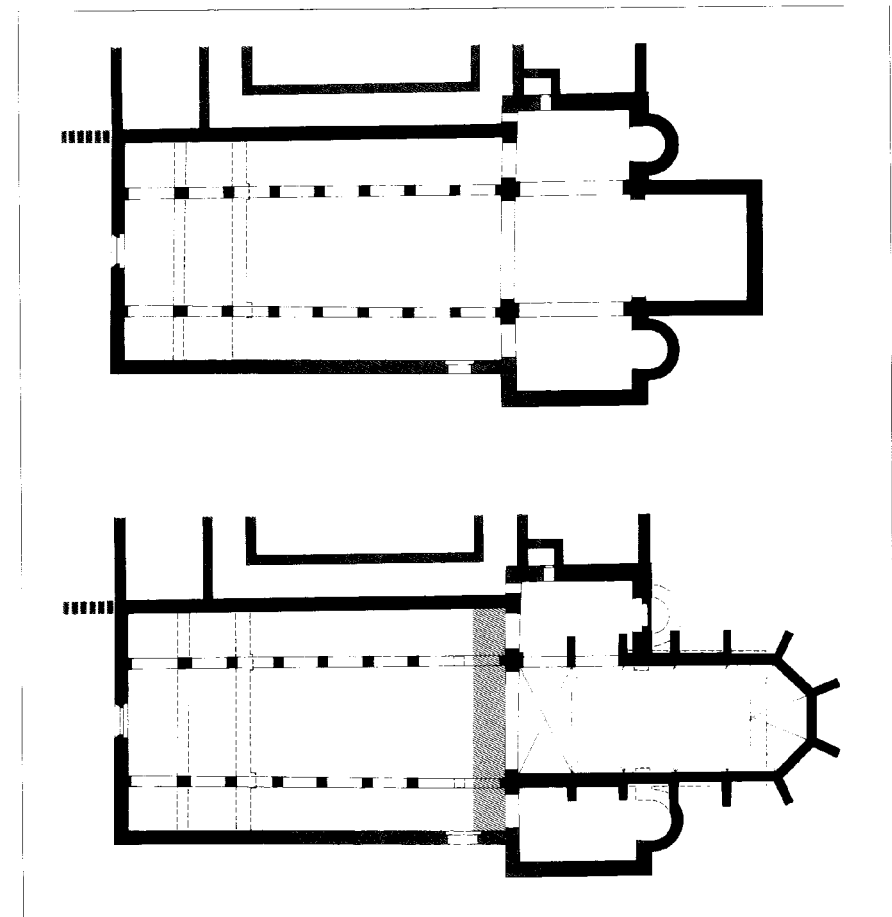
Zürich, Predigerkirche: Bau I (um 1250); Bau II (um 1350); Grundrisse.
